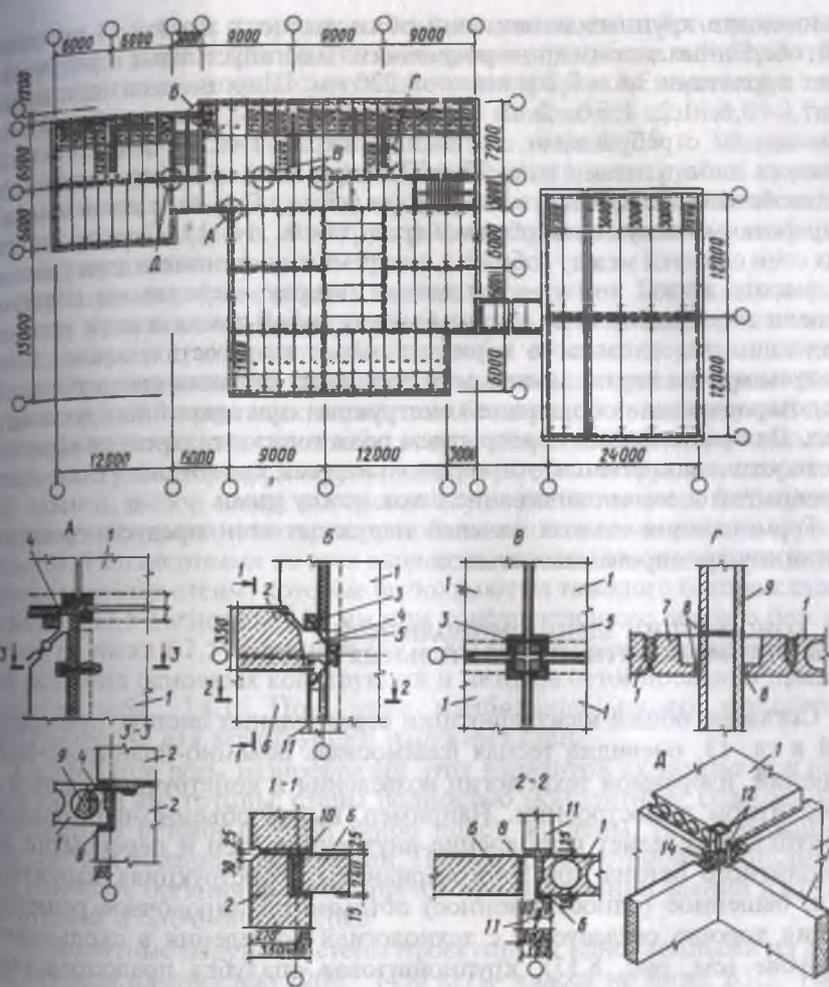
Монтажный план, узлы сопряжений настилов перекрытий и несущих стен и узел вертикальных межэтажных связей панелей внутренних стен:
